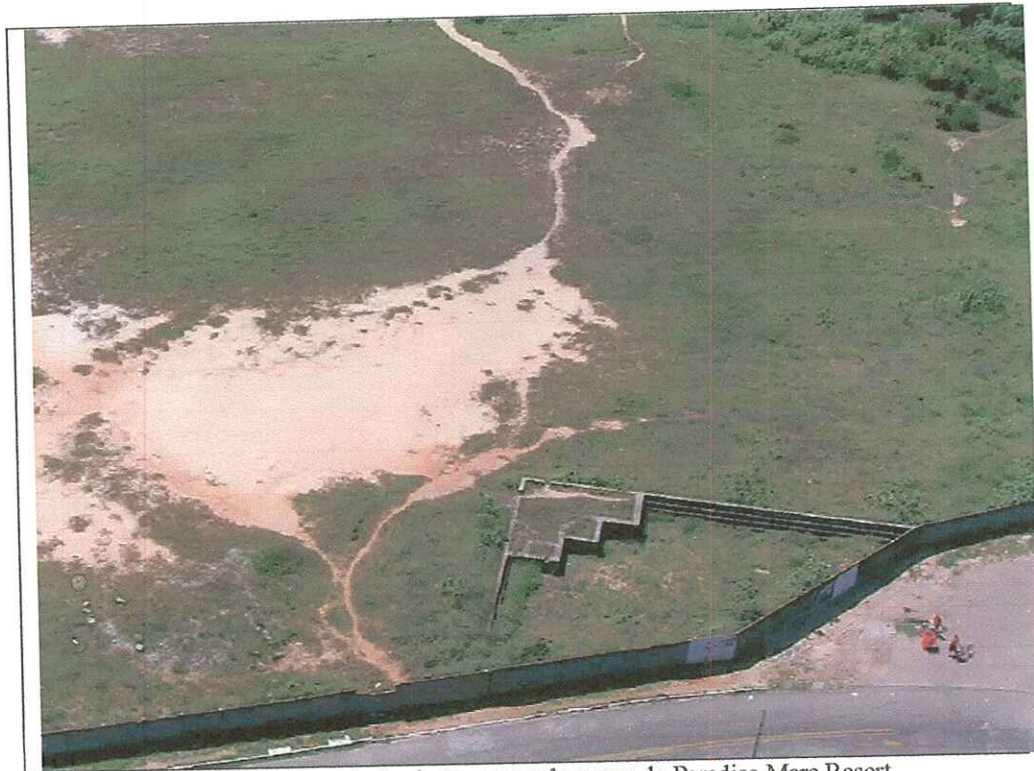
Obras de fundação e terraplenagem do Paradiso Mare Resort
